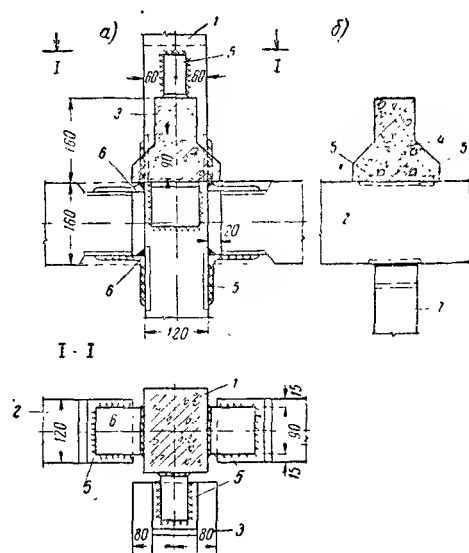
Сопряжение стоек каркаса двухэтажного дома с ригелями и балками
